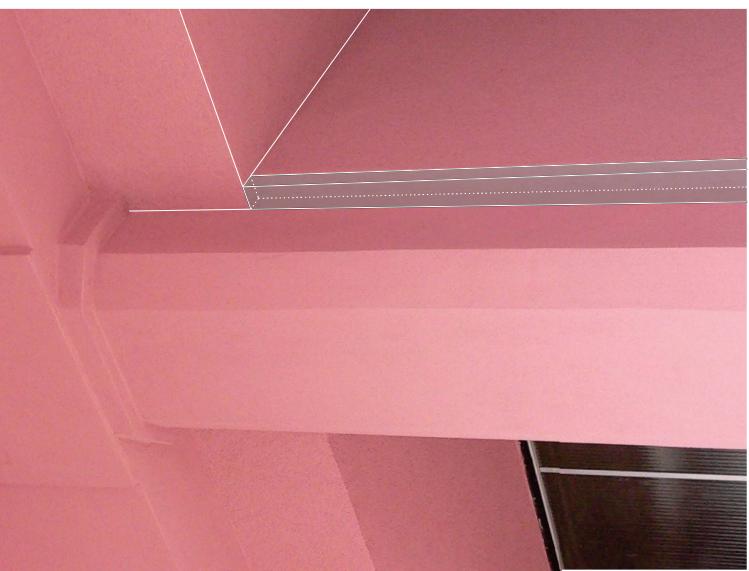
DETAIL DOPLNĚNÍ HRANY PILÍŘE U VSTUPU _ JIŽNÍ FASÁDA
